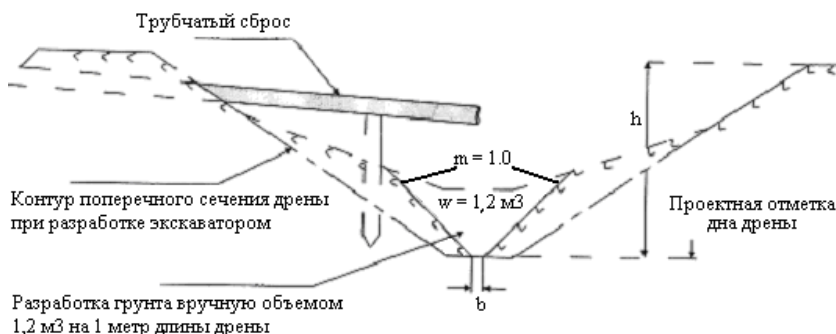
Поперечное сечение дрены. М – 1:50 (разработка грунта вручную)
